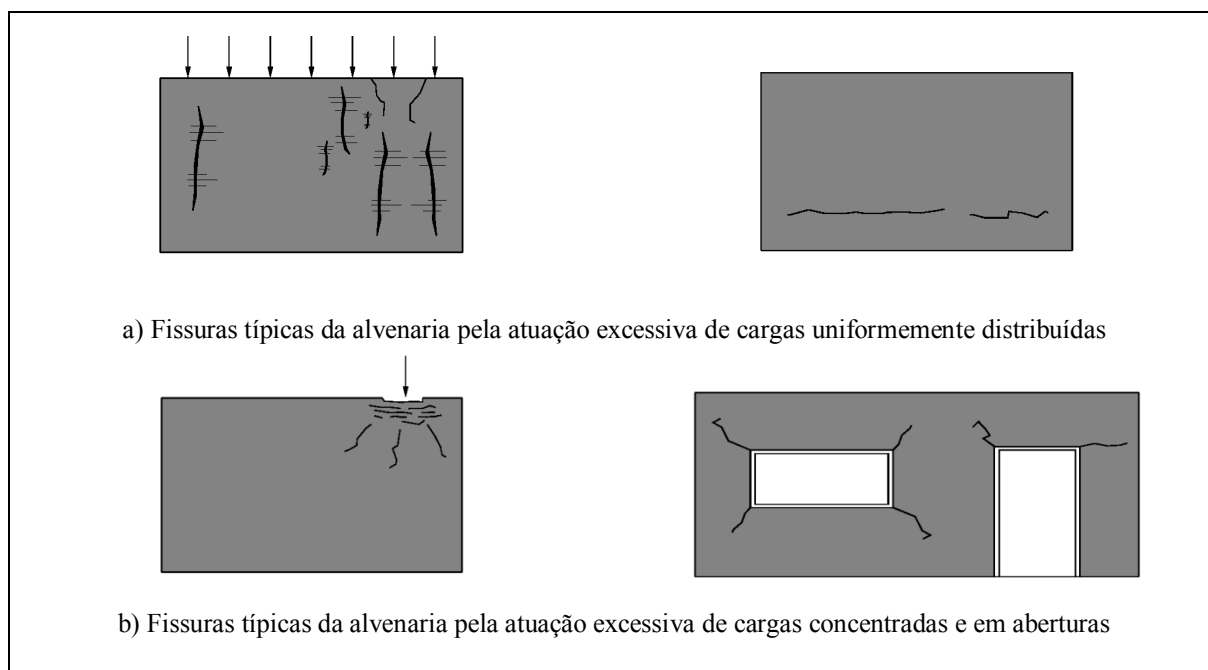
Fissuras devido à atuação excessiva de cargas (PEREIRA, 2005)
